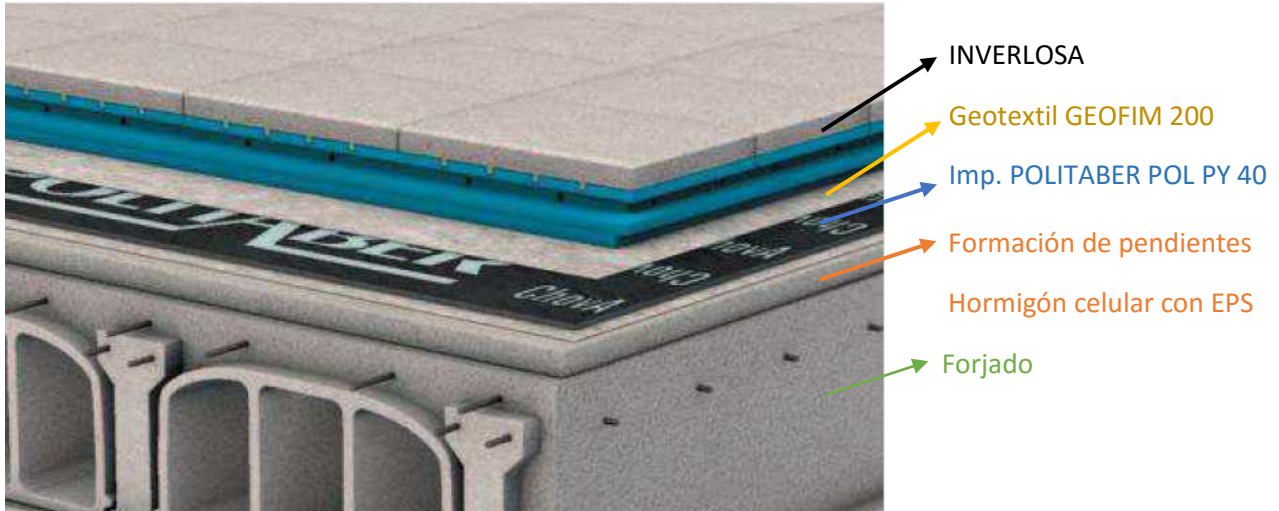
Sistema constructivo INVERLOSA Fuente: Aislampor 2016
